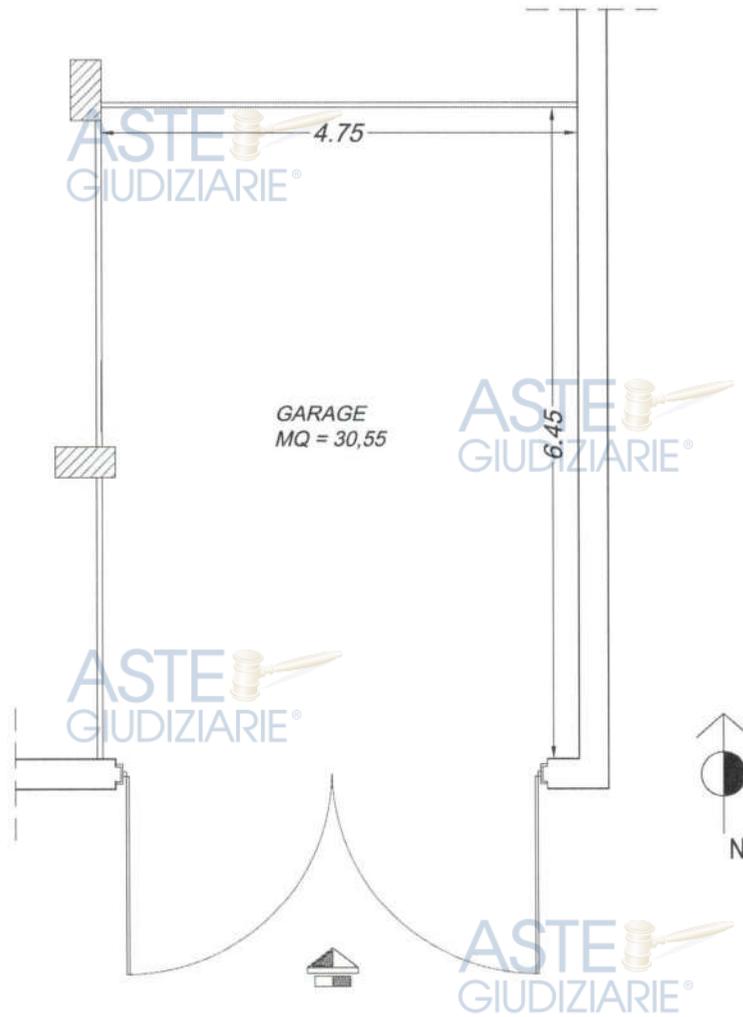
Planimetria Catastale Foglio 23, p.lla 371, sub 5 (ex sub 2) - Piano S1
